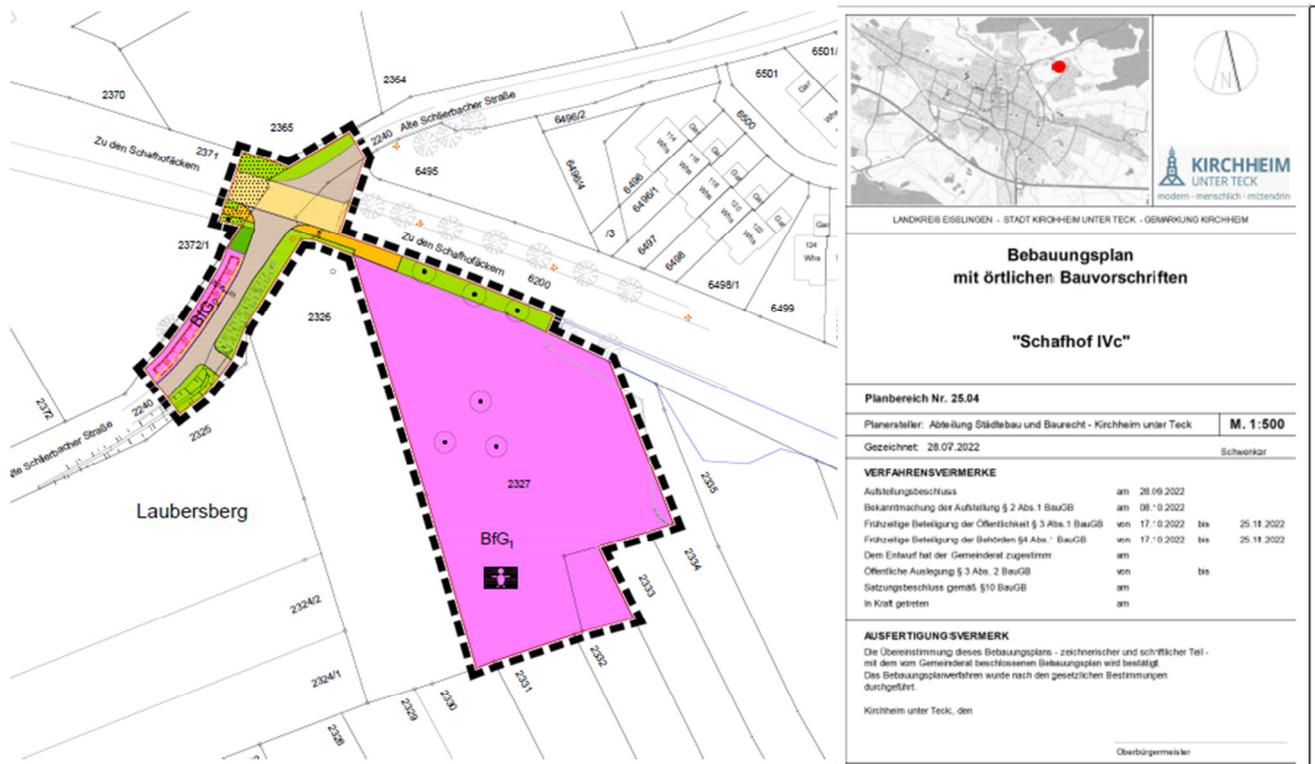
Bebauungsplan „Schafhof IV c“ mit Datum vom 28.7.2022, Stadt Kirchheim (Ausschnitte)
